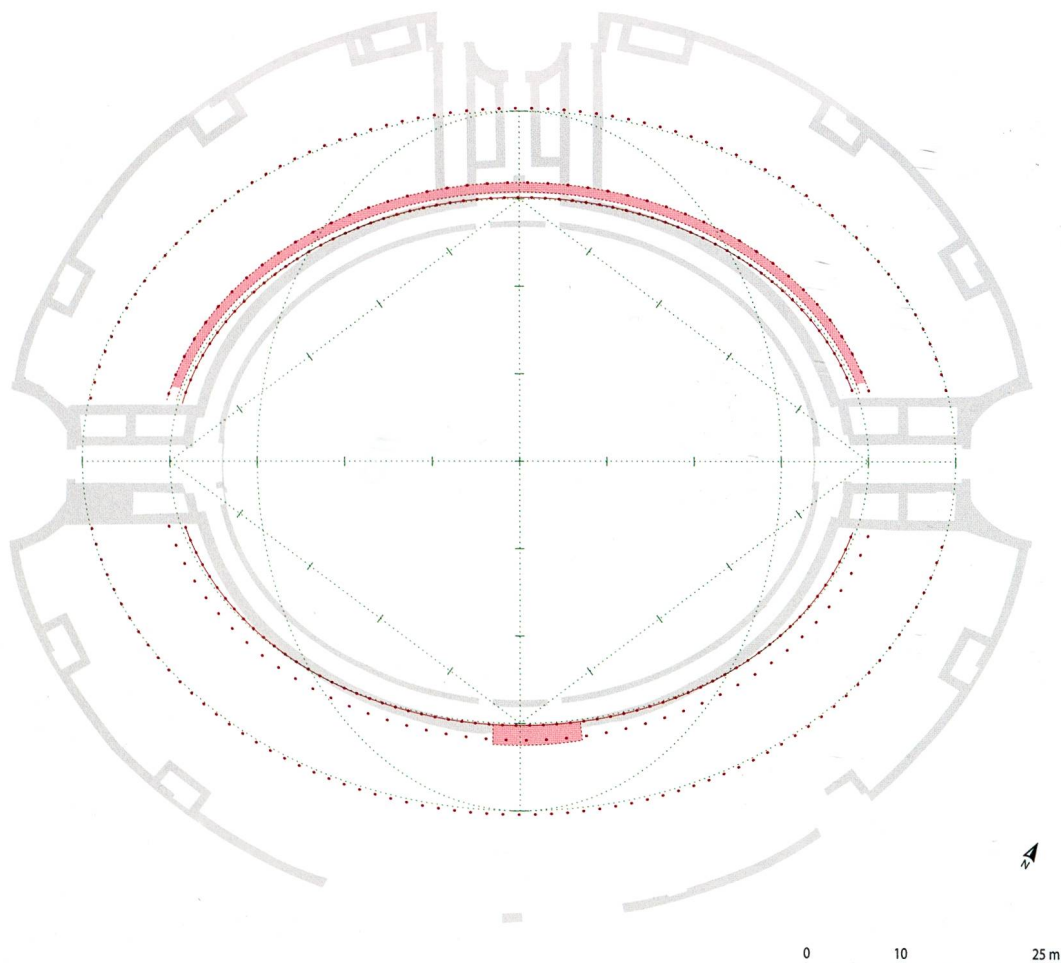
Amphitheater. Schematisch rekonstruierter Grundrissplan des Holzbaus (rot) mit theoretischer Planungsgeometrie (grün) und hinterlegtem Grundriss des Steinbaus (grau). M 1:800.
